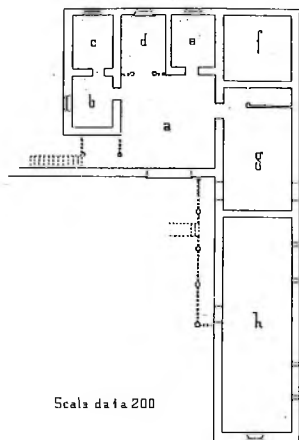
Idem. Edificio de Pisanella, planimetria do segundo piso (Pasqui, 1897, fig. 74).
